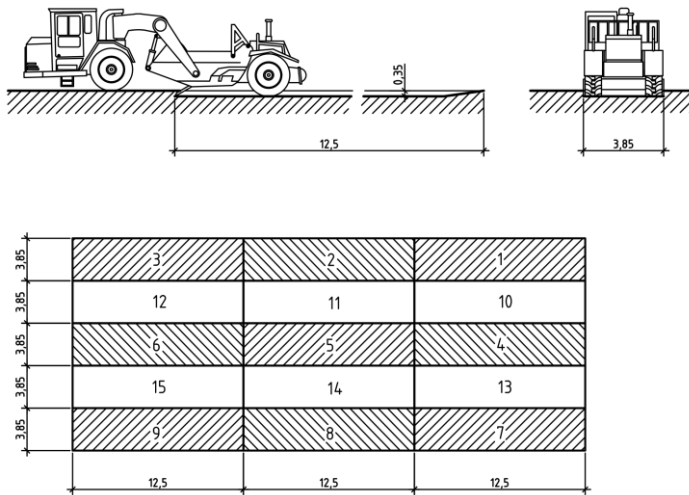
Схема резания грунта тонкой стружкой (а) и схема разработки грунта скрепером (проходка через полосу) (б); 1,2,3,... — последовательность разработки грунта
